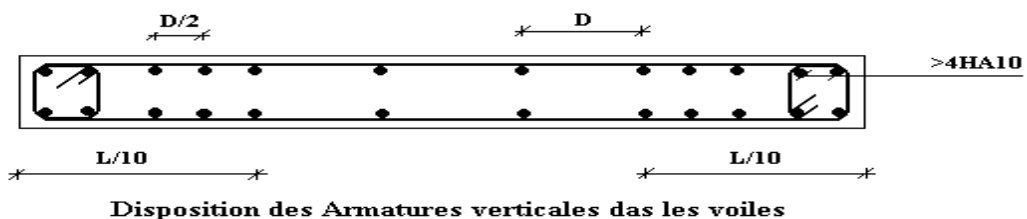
Disposition des Armatures verticales dans les voiles.
